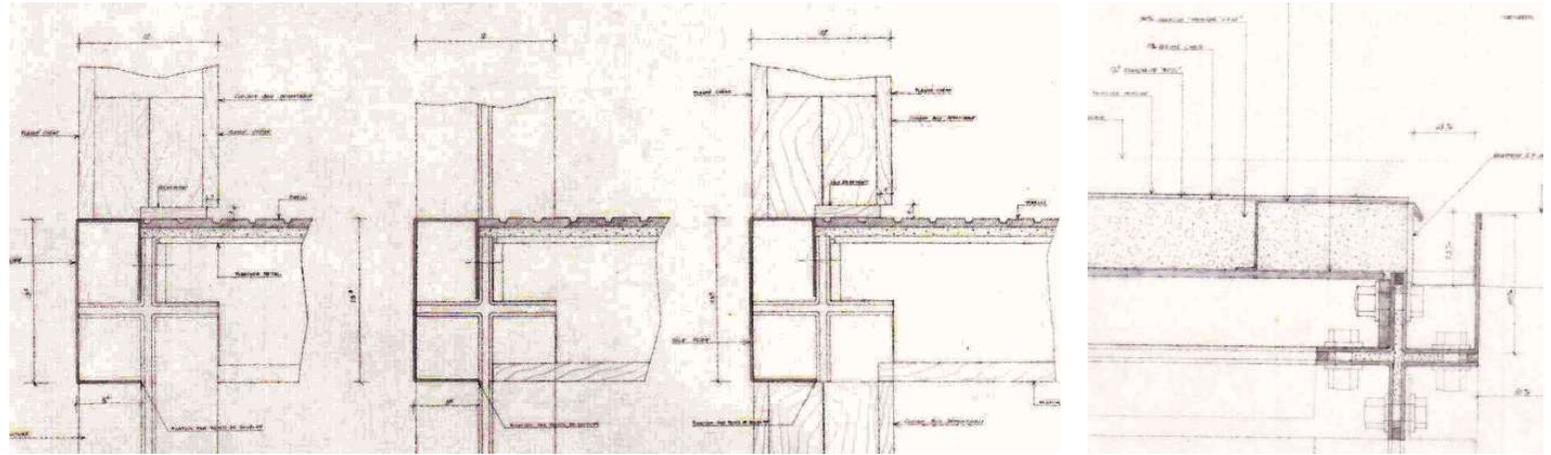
Detalles constructivos de los forjados,plano nº276. 1 de nero de 1967.
